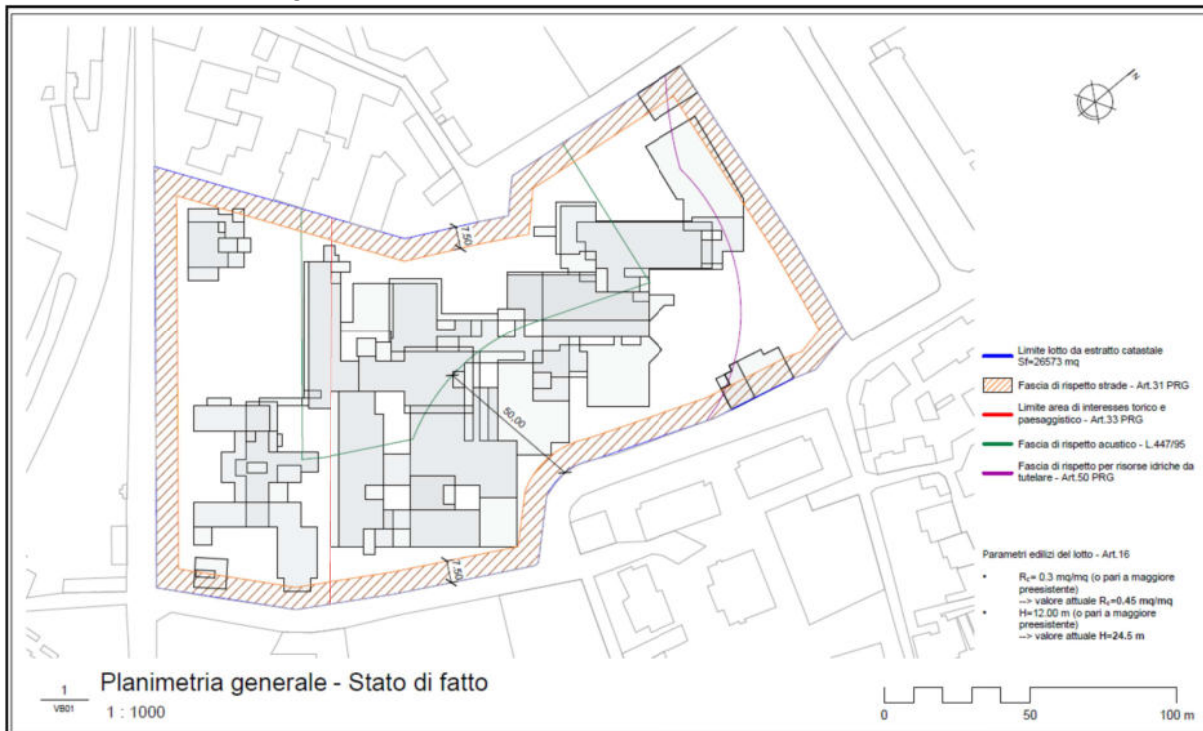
| Fasce di Rispetto con individuazione dell'area oggetto di intervento.
